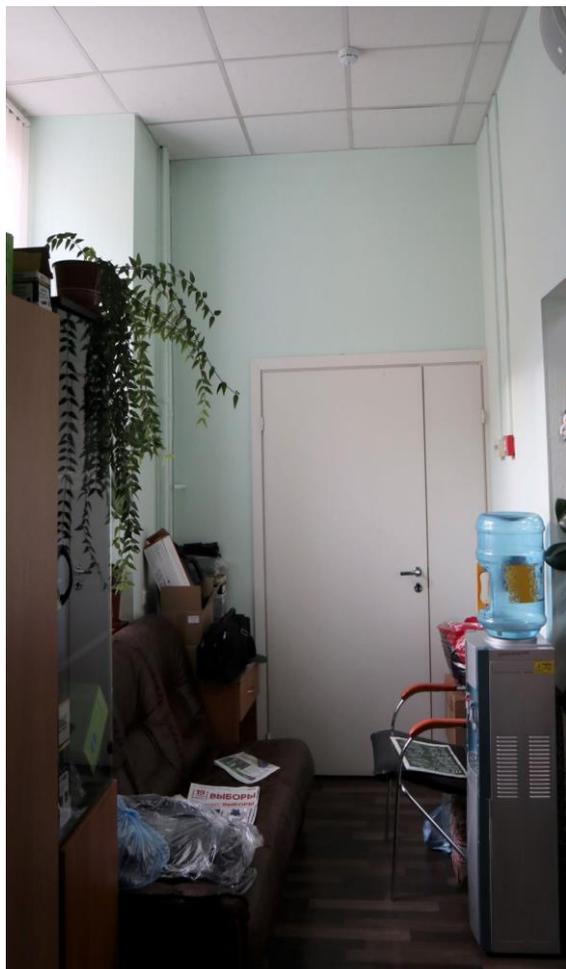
1 этаж, служебное помещение, 18Н (2).
